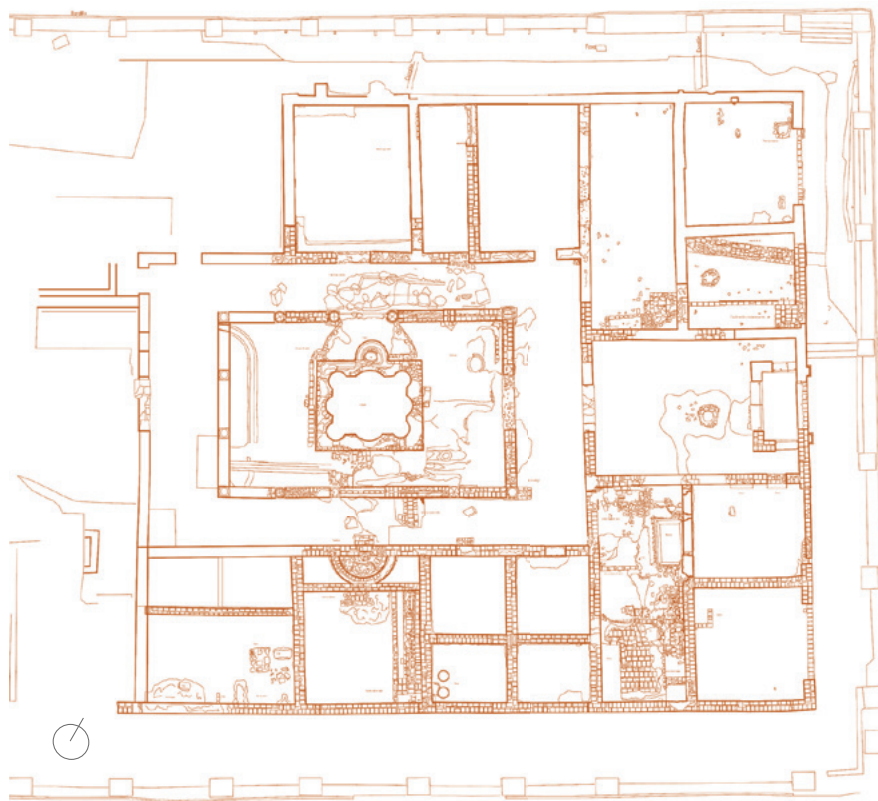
Plano del estado actual de la Casa de la Cañada Honda (fuente: R. Angulo, 2009. *Elaboración de las fichas diagnóstico de los bienes inmuebles del CAI*)
